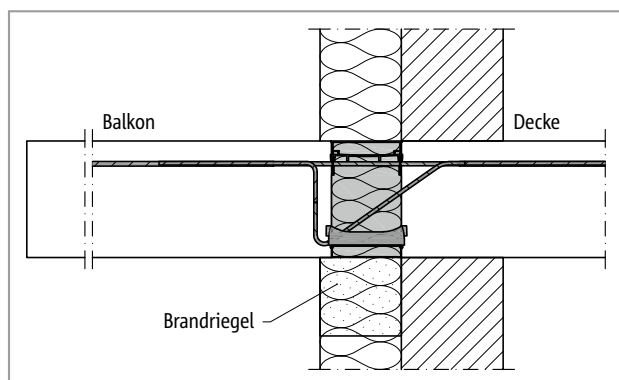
Schöck Isokorb® XT Typ K-...-R0: WDVS mit Brandriegel
